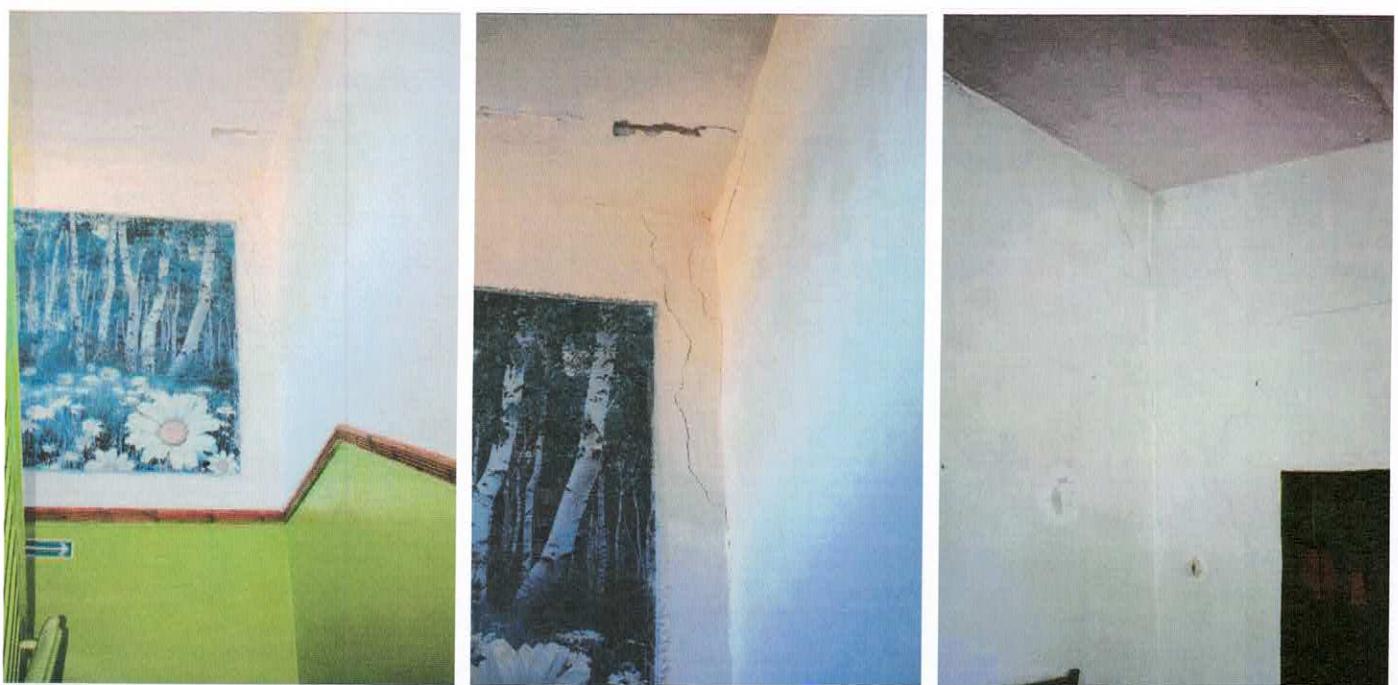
Трешины в кладке внутренних стен
